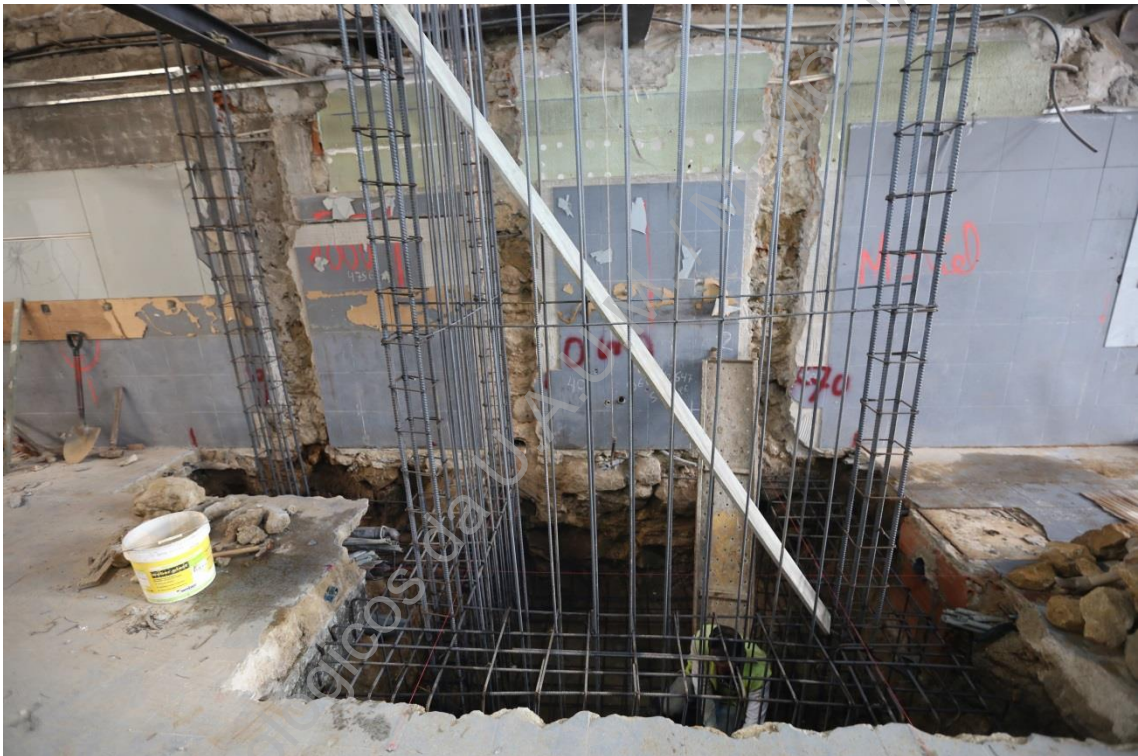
(IMG_2076) – Armadura de ferro para betonagem da sapata 2 (N/S).
